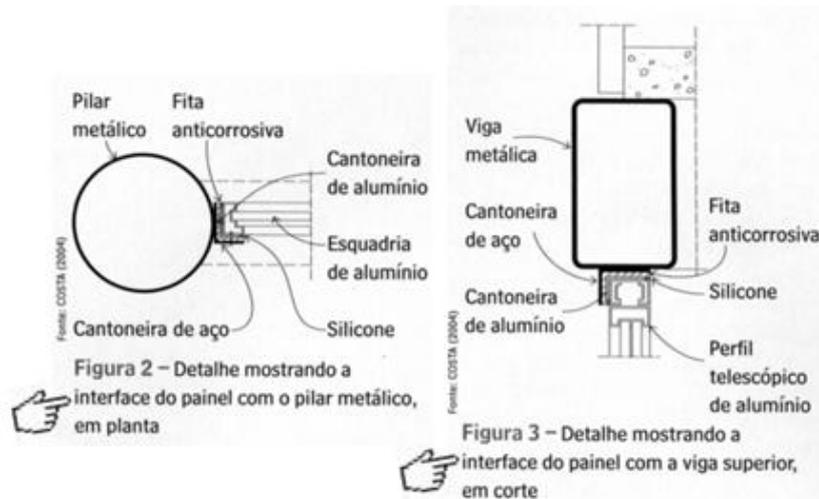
Interfaces físicas entre estrutura metálica, perfis de alumínio e laje de concreto.
